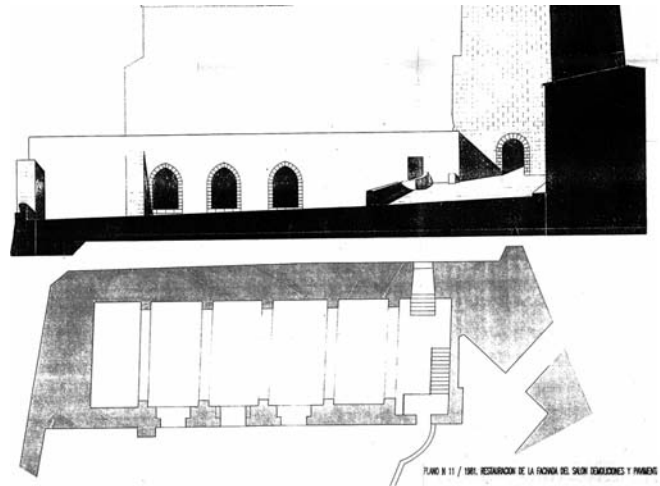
1981. Planta y Alzado del Salón. Solución Adoptada. Silla
